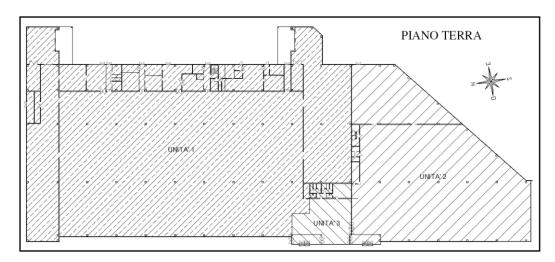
Planimetria dell'edificio ad uso commericale suddiviso in unità
